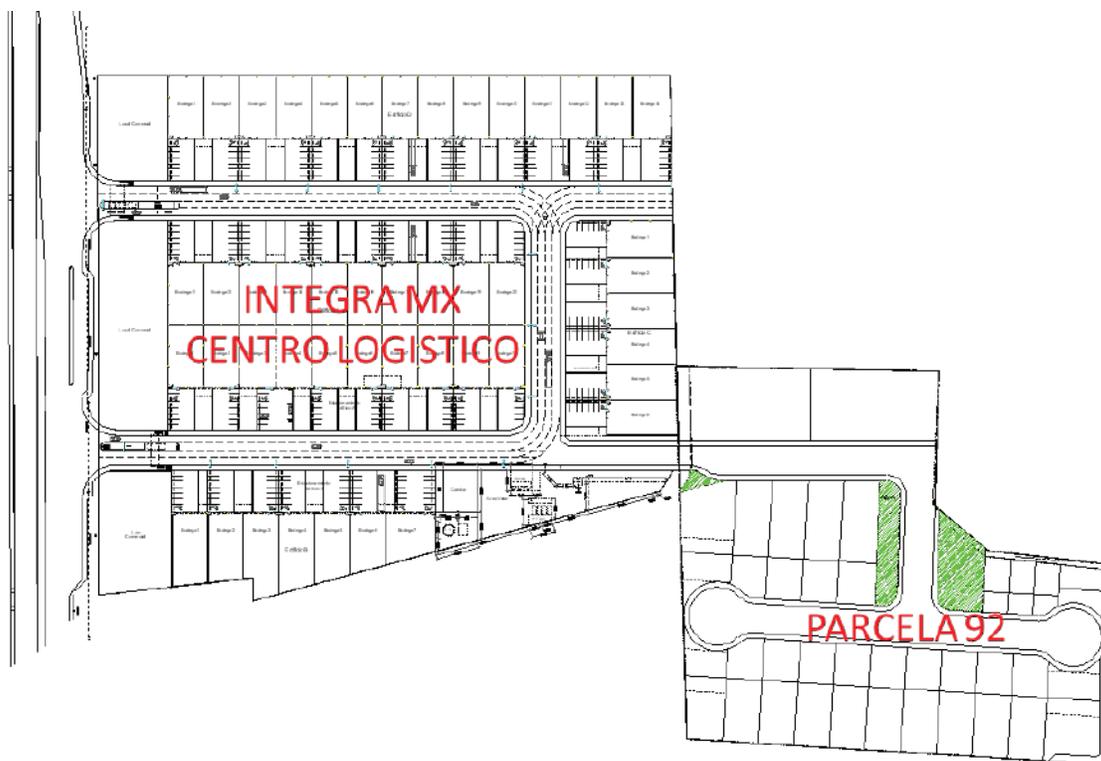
Propuesta de lotificación. Fuente: Arquitectura en Proceso.
